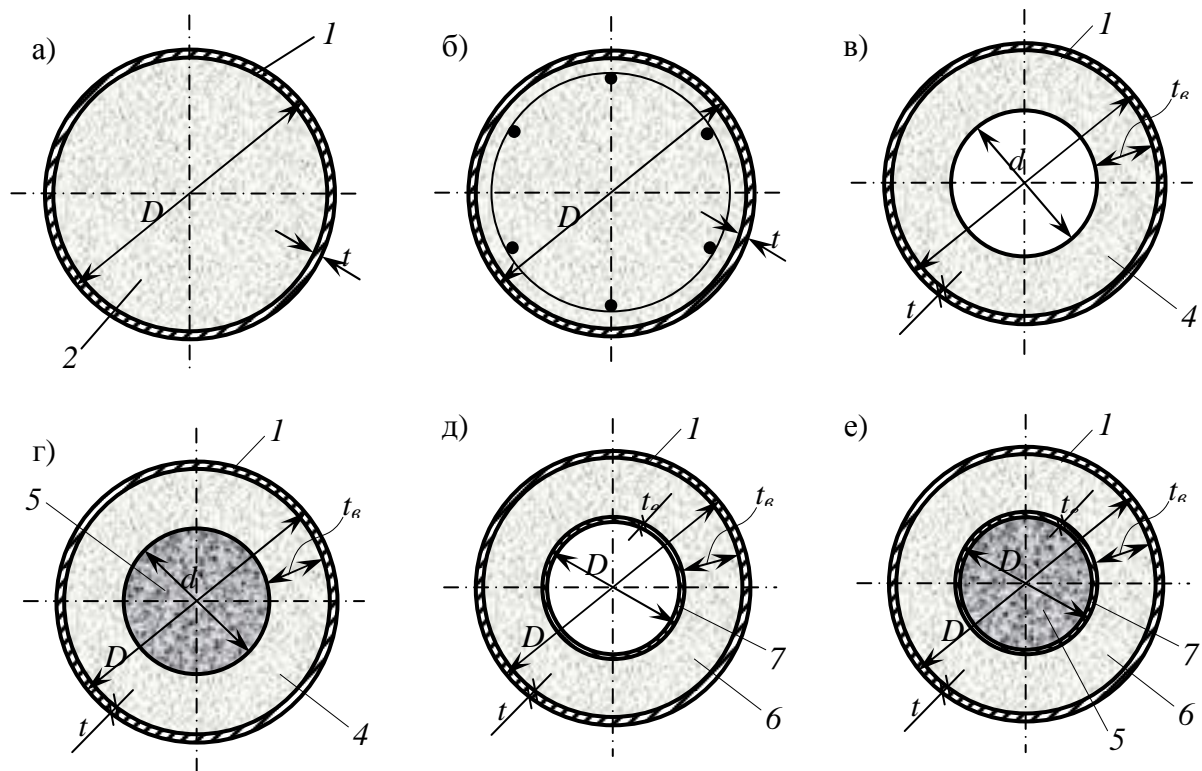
Перерізи дослідних зразків: а – групи I; б – групи II; в – групи III; г – підгрупи IIIа; д – підгрупи IIIб; 1 – труба-оболонка; 2 – осердя з високоміцного бетону ; 3 – бетонне осердя з поздовжньою арматурою; 4 – центрифугований бетон; 5 – бетон, що заповнює порожнину; 6 – бетон між трубами; 7 – внутрішня труба
